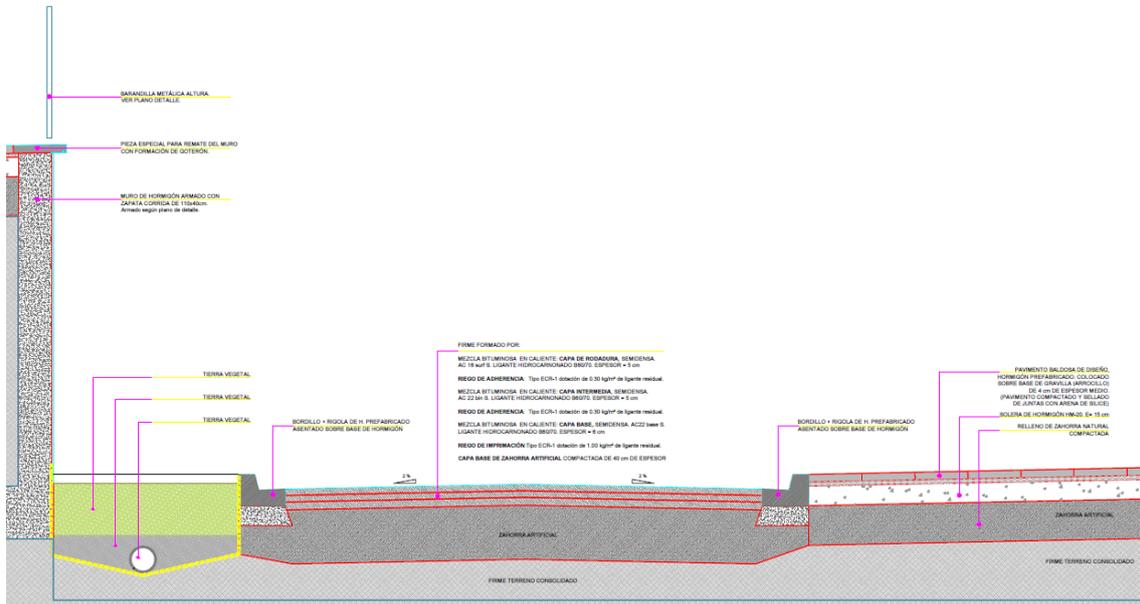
Detalle pavimento sección transversal viario lateral. Lado Este
